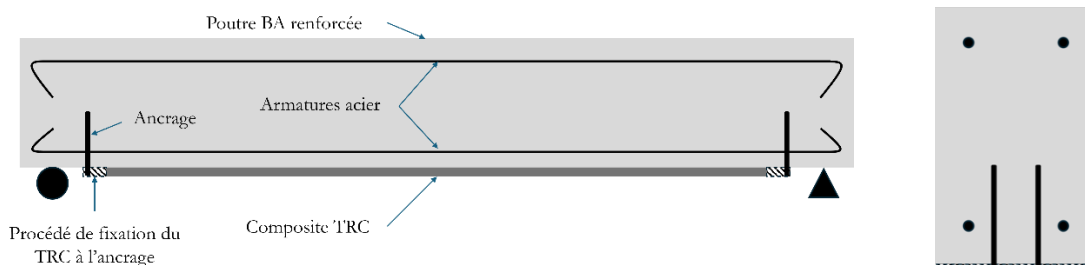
Schéma d'une poutre renforcée par un TRC avec ancrage mécanique : coupe longitudinale de la poutre (figure à gauche) ; coupe transversale de la poutre (figure à droite)
